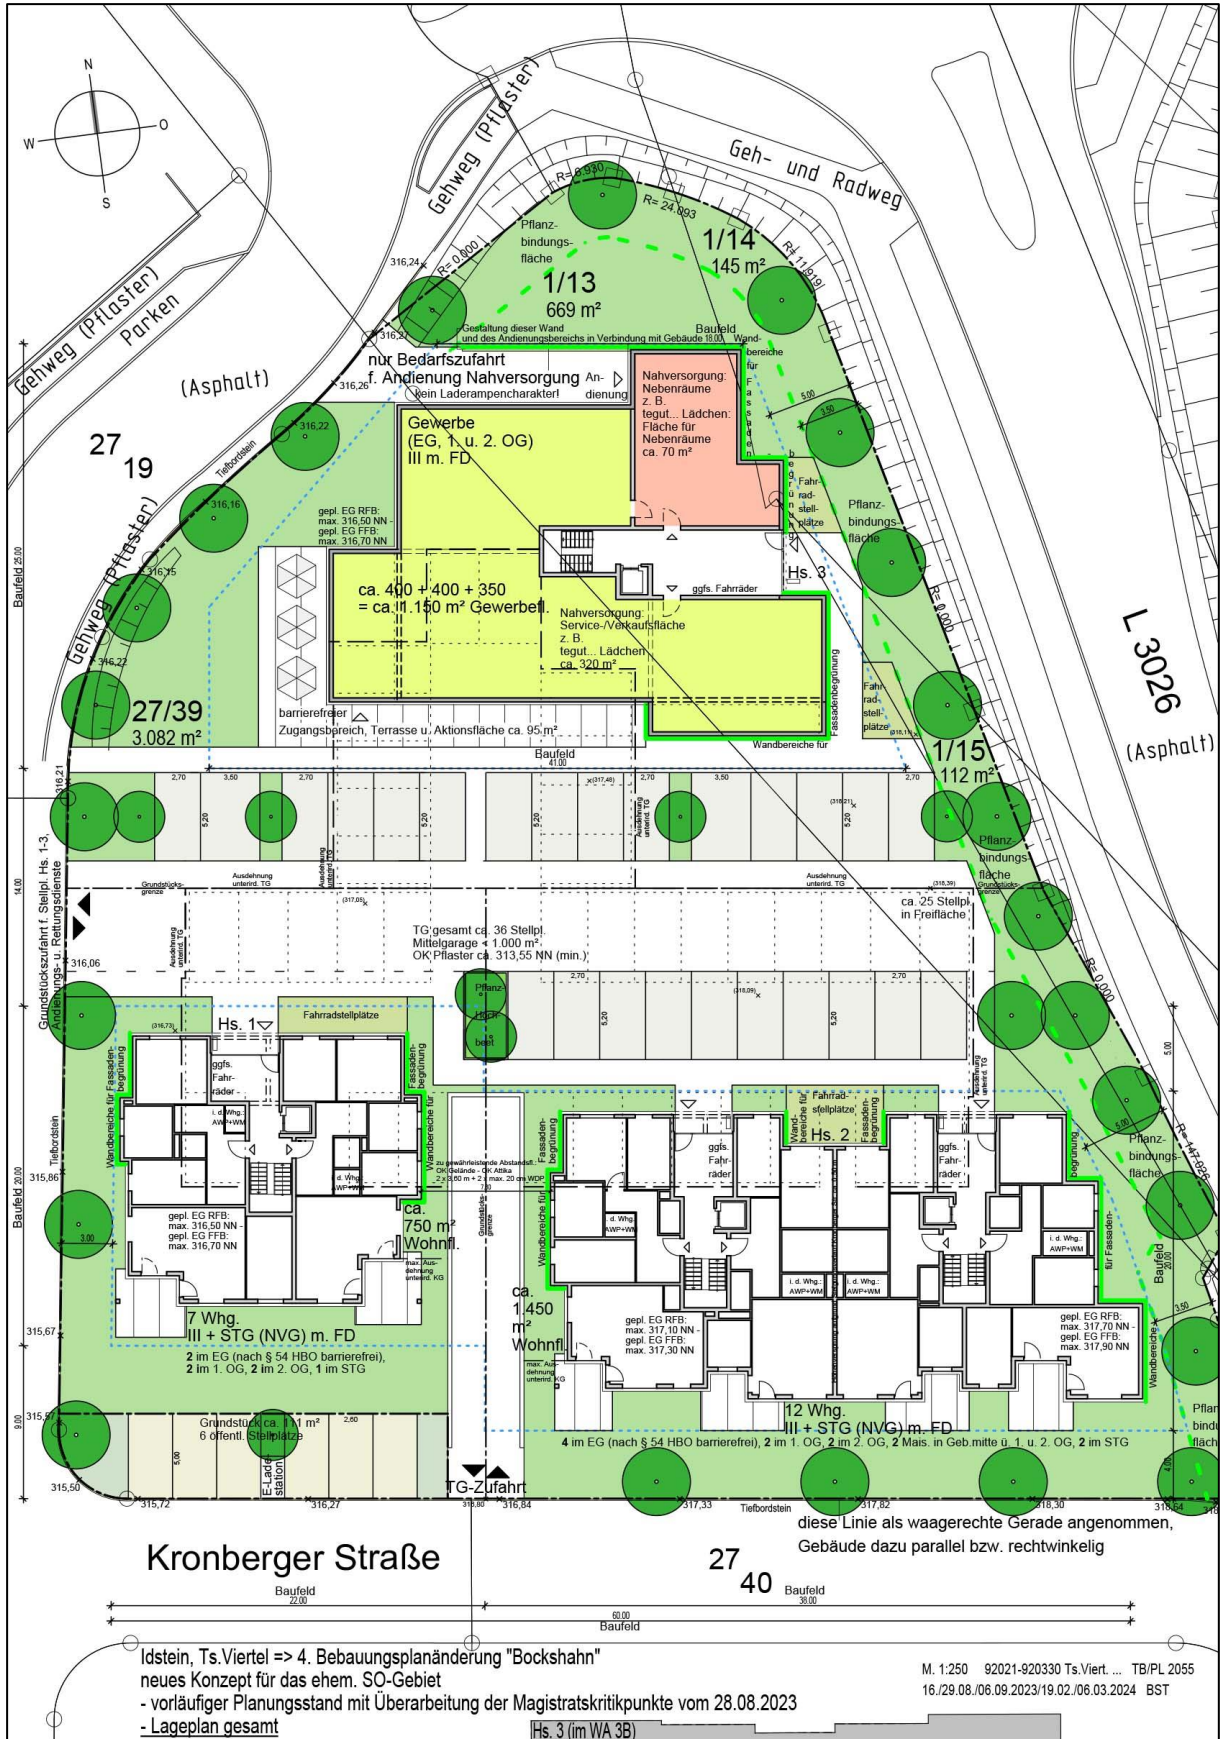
Lageplan der geplanten Bebauung (vorläufiger Planungsstand – Konzept) - Quelle: Firma Bücher, Idstein
